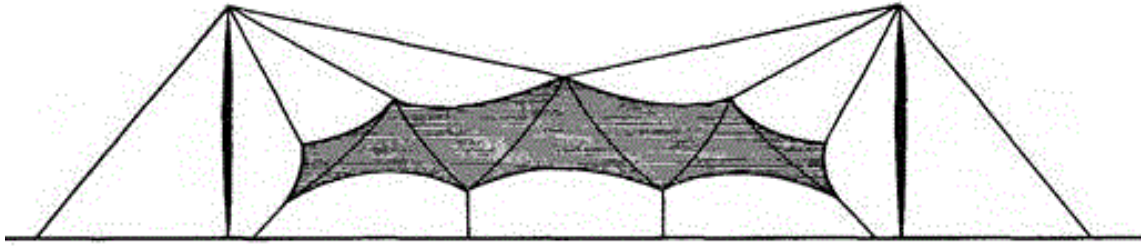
Зовнішня конструкція опор з внутрішніми відтягненнями для формування вершин. [4]
